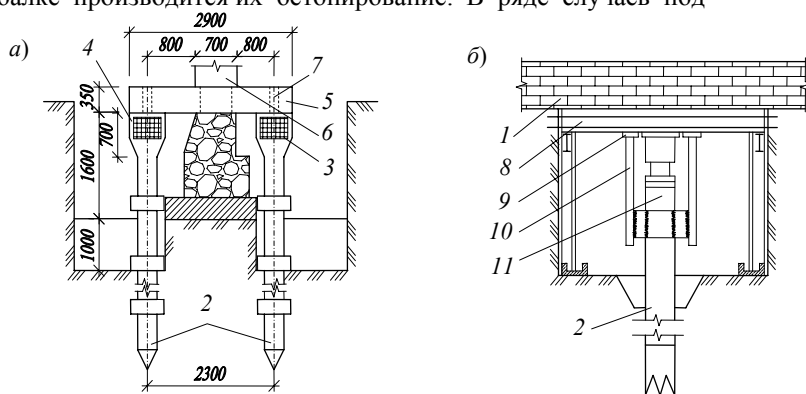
Варианты усиления фундаментов трубчатыми задавливаемыми сваями:
